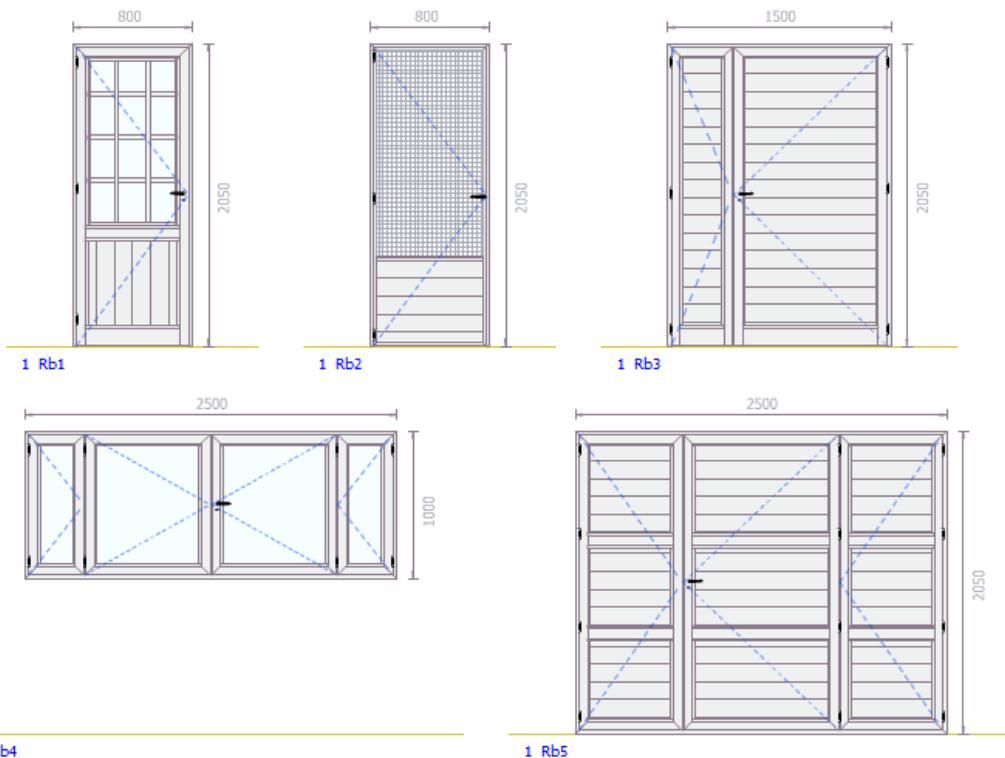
Puerta rebatible con Vidrio Repartido en el módulo superior y revestimiento Doble Faz el inferior (Rb1). Puerta rebatible mosquitera, con paño inferior doble faz (Rb2). Puerta Rebatible con hoja maestra de mayor porte (Rb3). Ventana rebatible de 4 hojas, con hojas activa y pasiva de mayor porte (Rb4). Portón Rebatible con Doble Faz horizontal, de tres hojas, dos travesaños promediados y hoja maestra central más ancha que las dos laterales. Observar que el sistema indica 4 bisagras por hoja (Rb5).
